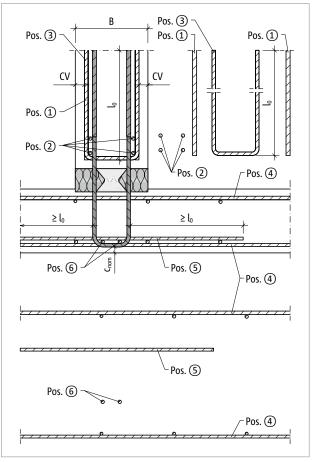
Schöck Sconnex® type W-NT-B : renforcement sur site dans le cas d'un ancrage de l'effort de traction dans la dalle avec une armature supplémentaire en Pos. 5
